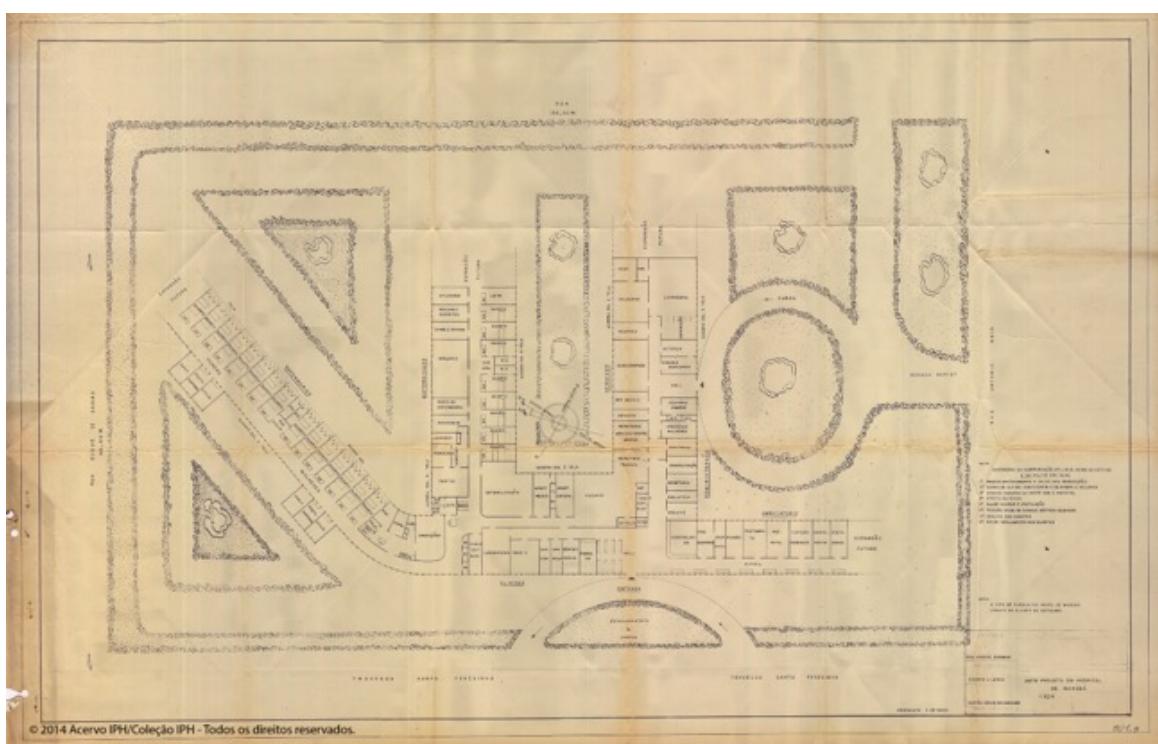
Plano con la planta baja de la primera versión del Hospital de Marabá
